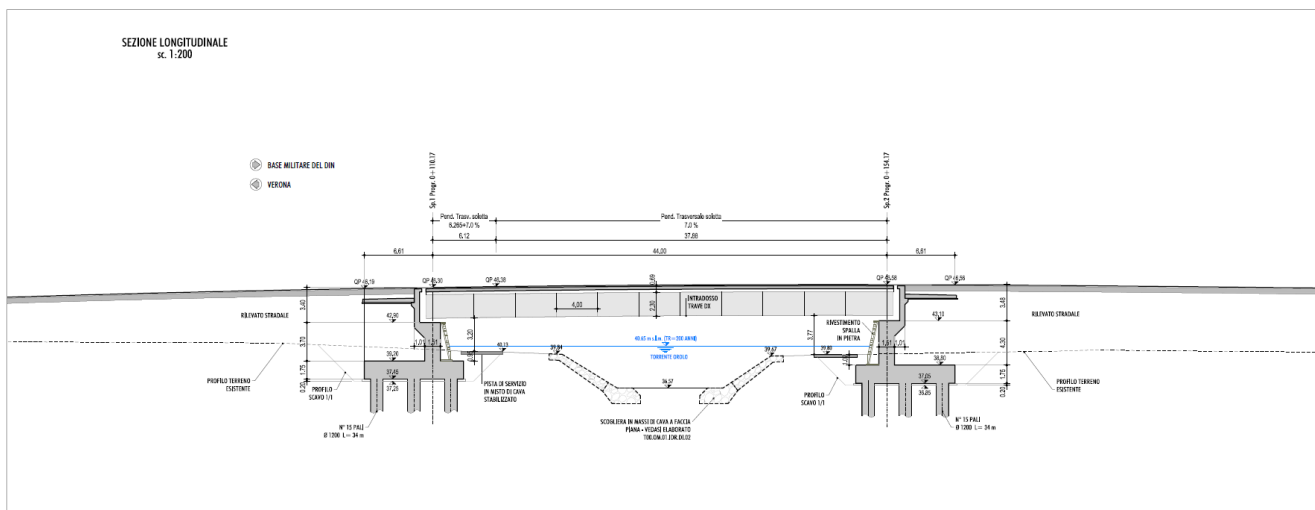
SEZIONE LONGITUDINALE DEL PONTE
